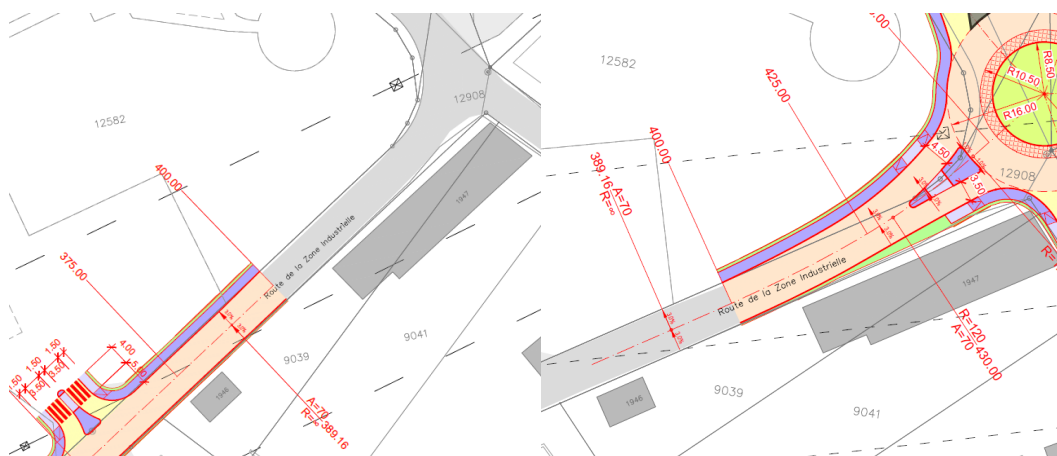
Plans de situation Ouest et Est se raccordant au tracé existant au repère 400
